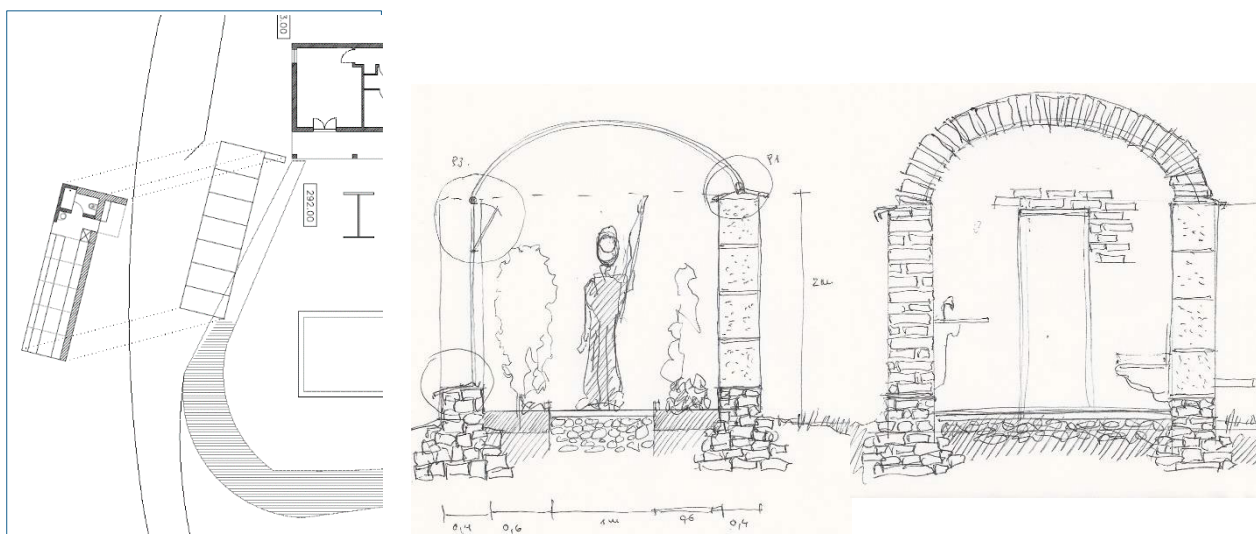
Planta e secções da estufa e zona da instalação sanitária.
